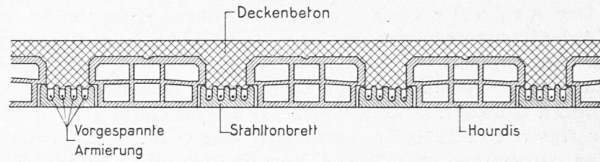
Aufbau der Stahlton-Hourdis-Decke
